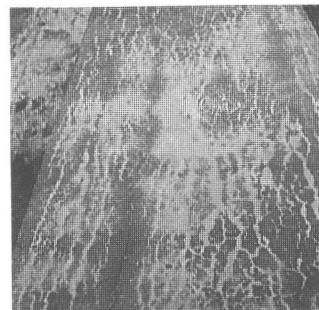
橋軸方向のひび割れ(事例イ)
